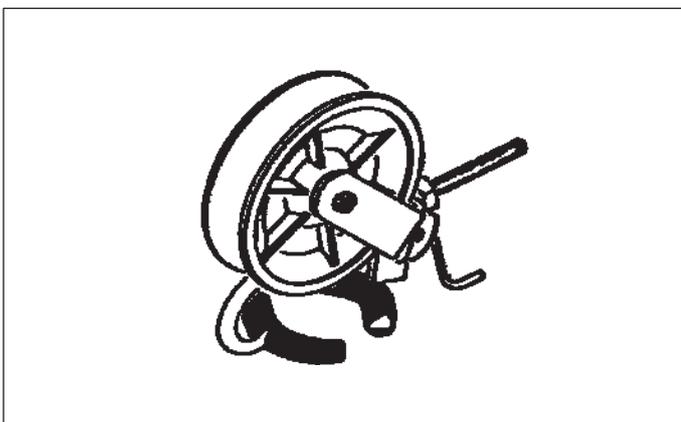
Монтажный ролик с креплением на опорный изолятор.
